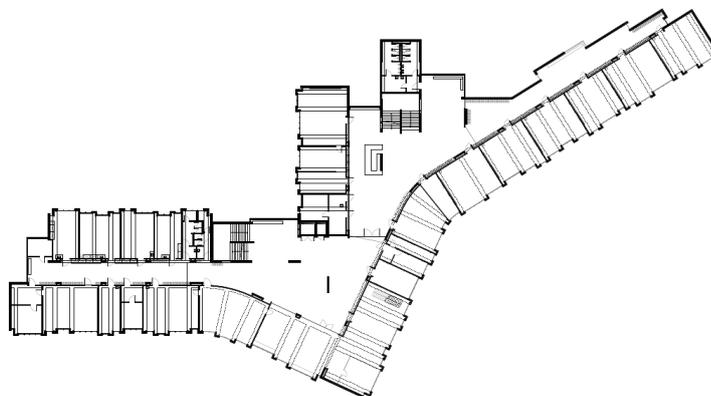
, Grundriss 1. OG. LG/RG-Trakt
